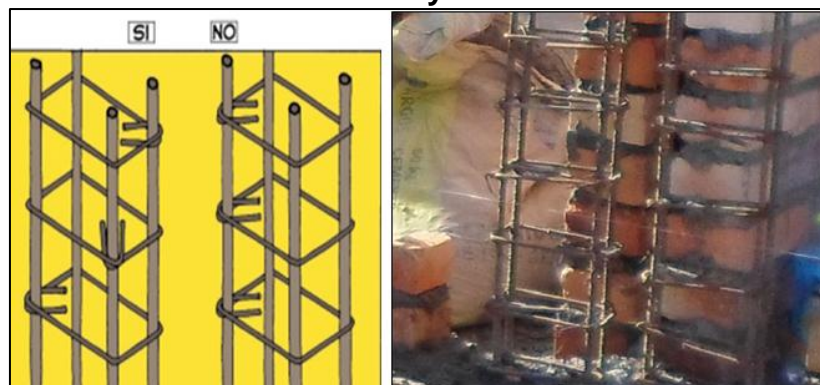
Muro y armado de refuerzo para columna de confinamiento
